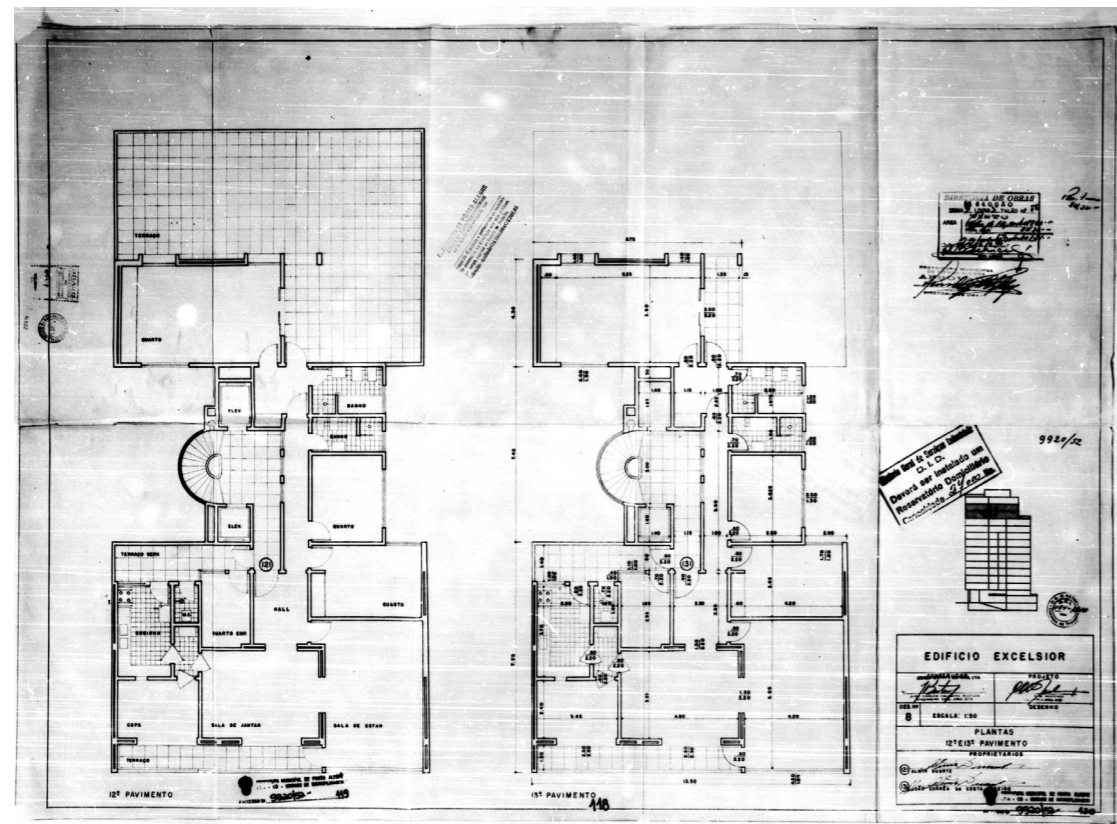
Planta Baixa 12º e 13º pavimentos do Edificio Excelsior. Fonte: BUENO, 2012.
